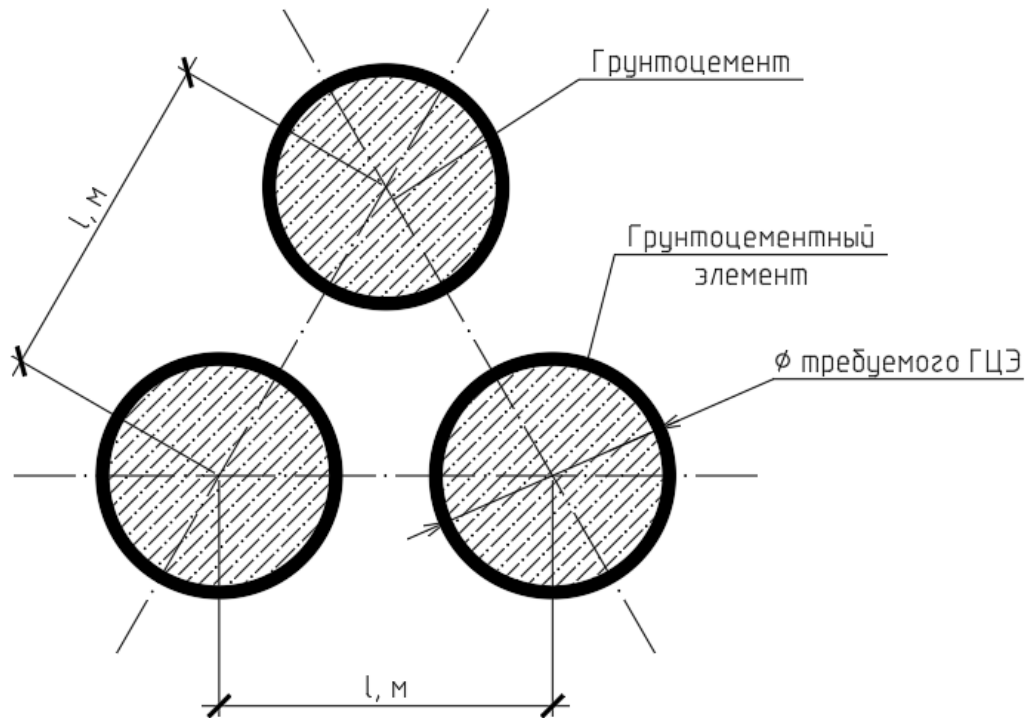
Схематичный план расположения ГЦЭ
